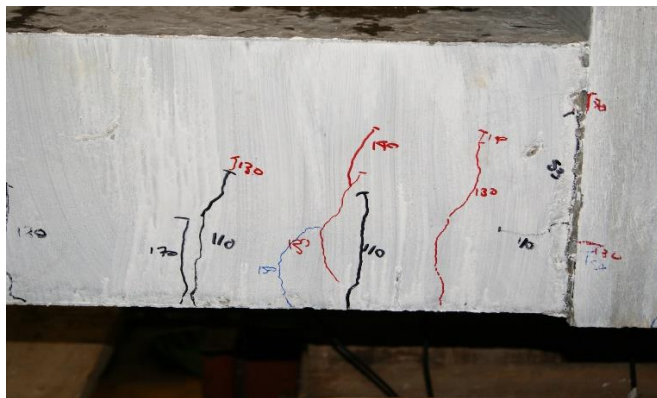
Patron de fissuration du modèle expérimental du spécimen avec un joint droit à la rupture
